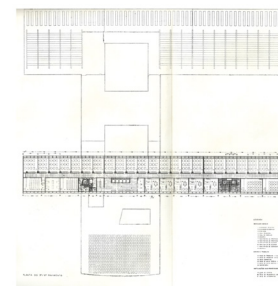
Planta baixa do pavimento-tipo do projeto para o edifício da FNA na Cidade Universitária, Rio de Janeiro.
